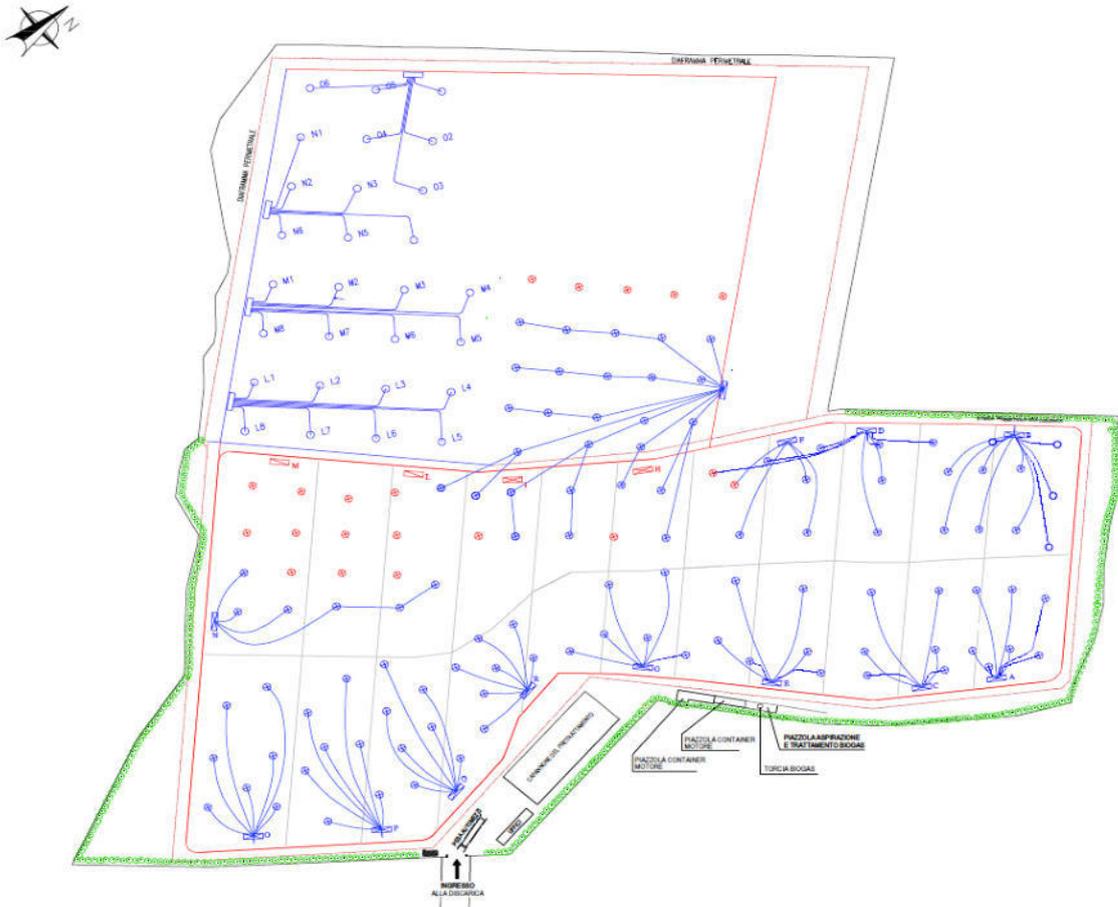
Planimetria stato di fatto impianto di captazione biogas al 30/06/2022
